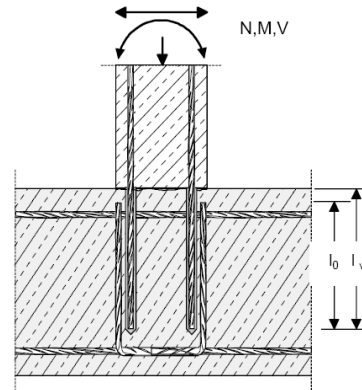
giunzione per sovrapposizione di pilastri sollecitati a flessione o muri a fondazioni.
